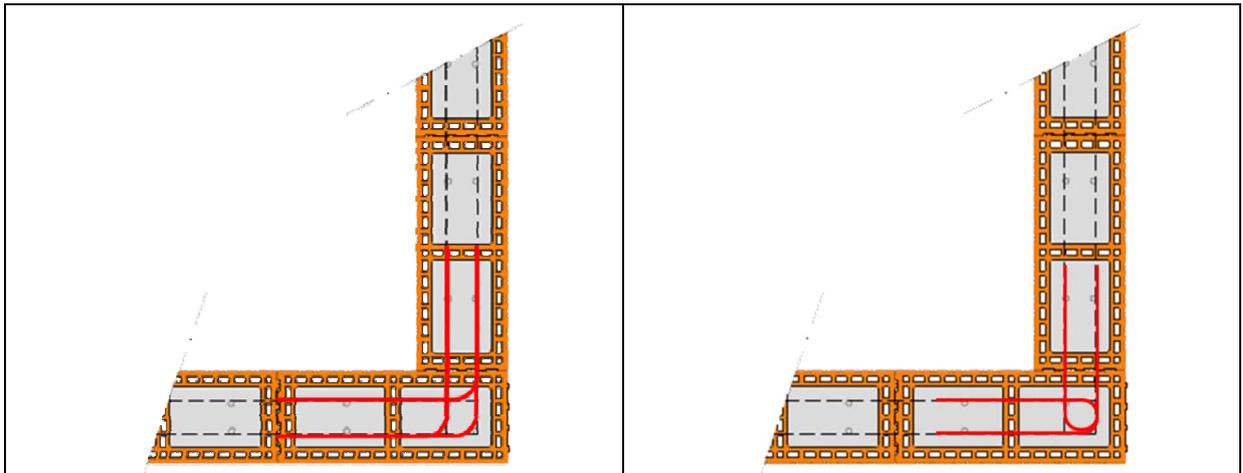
Principe de ferrailage (coupe horizontale) : recouvrement des armatures d'angles
